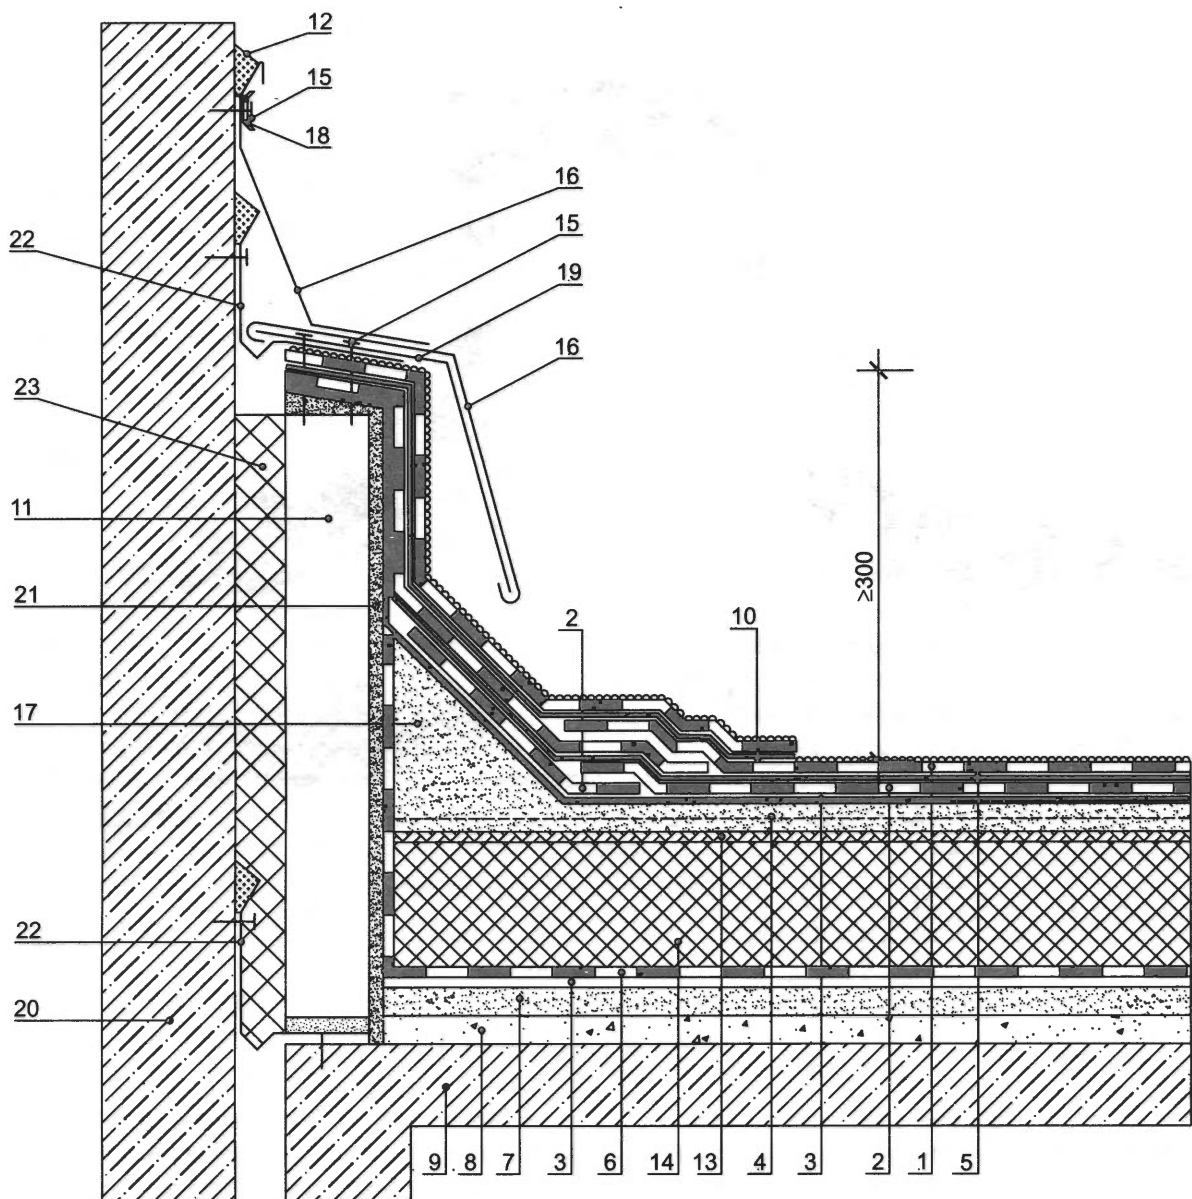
Узел примыкания кровли к стене. Гидроизоляция примыкания полиуретановой мастикой «Полилайн»
